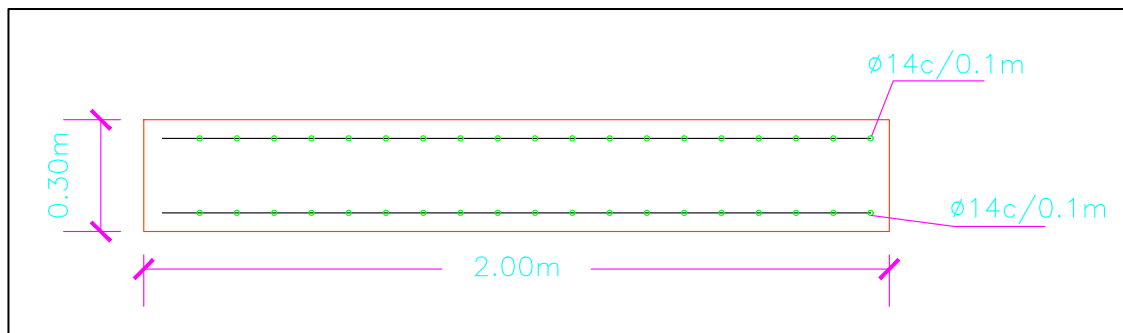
Dimensionamiento de la losa para el muelle secundario. Fuente: Autores
